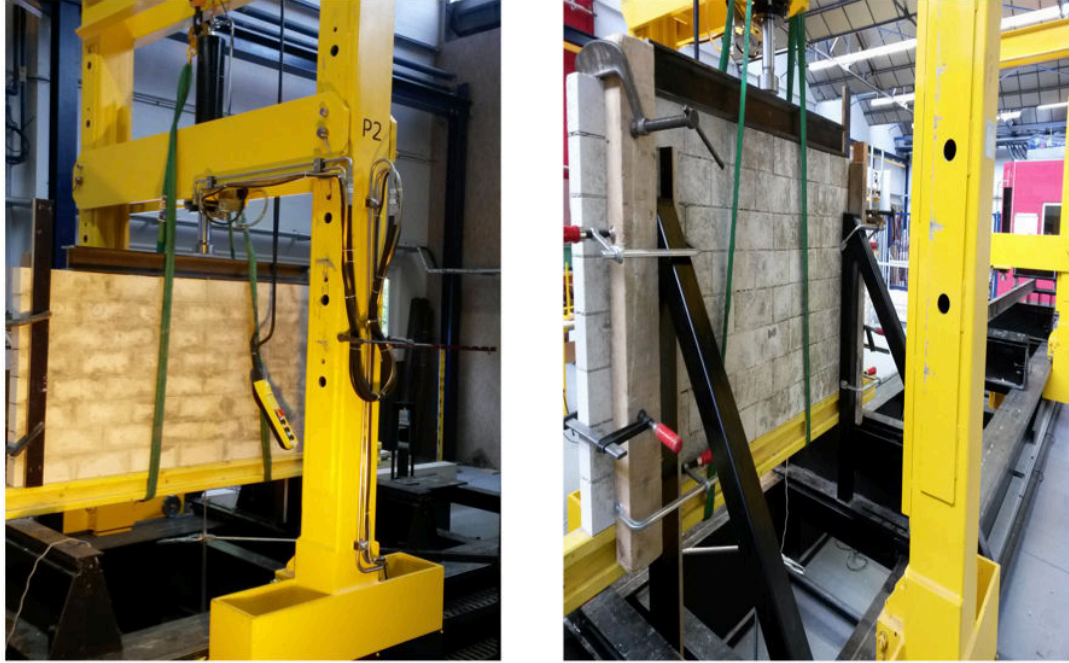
Illustration de l'installation du système (mur avec mortier F2)
